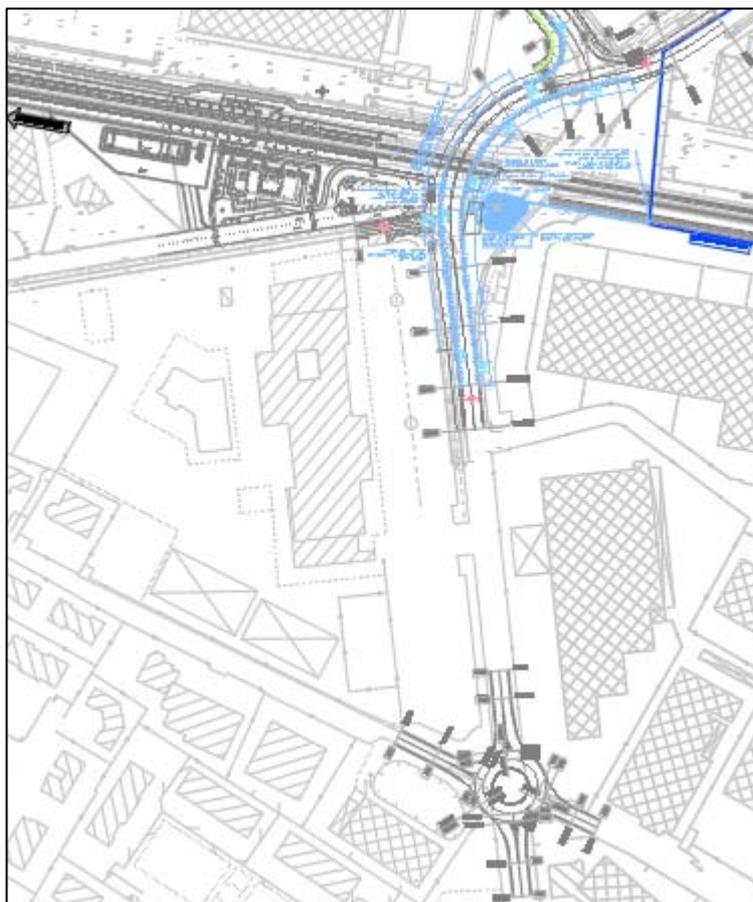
Stralcio planimetrico sistema di drenaggio.
